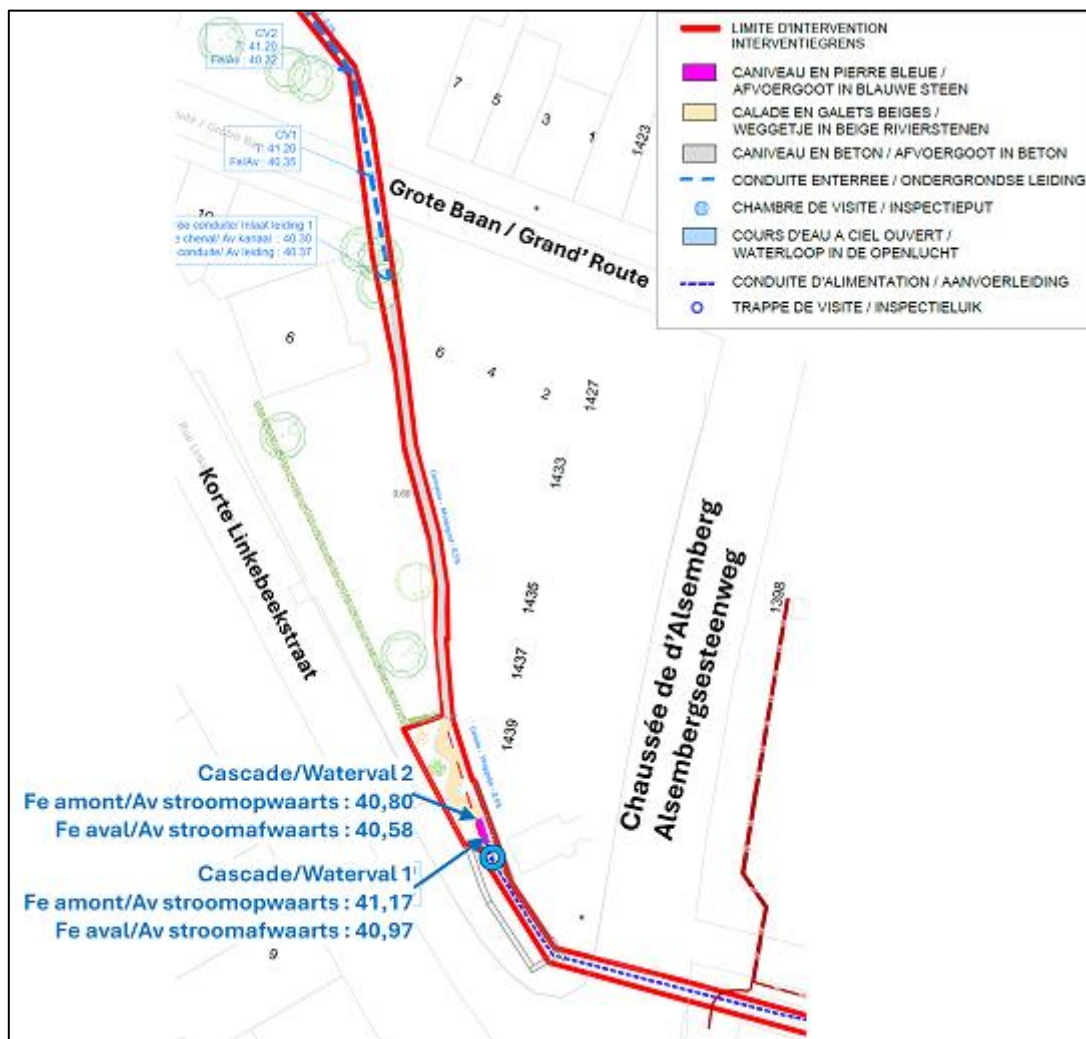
Partie en caniveau entre chaussée d'Alseberg et Grote Baan
